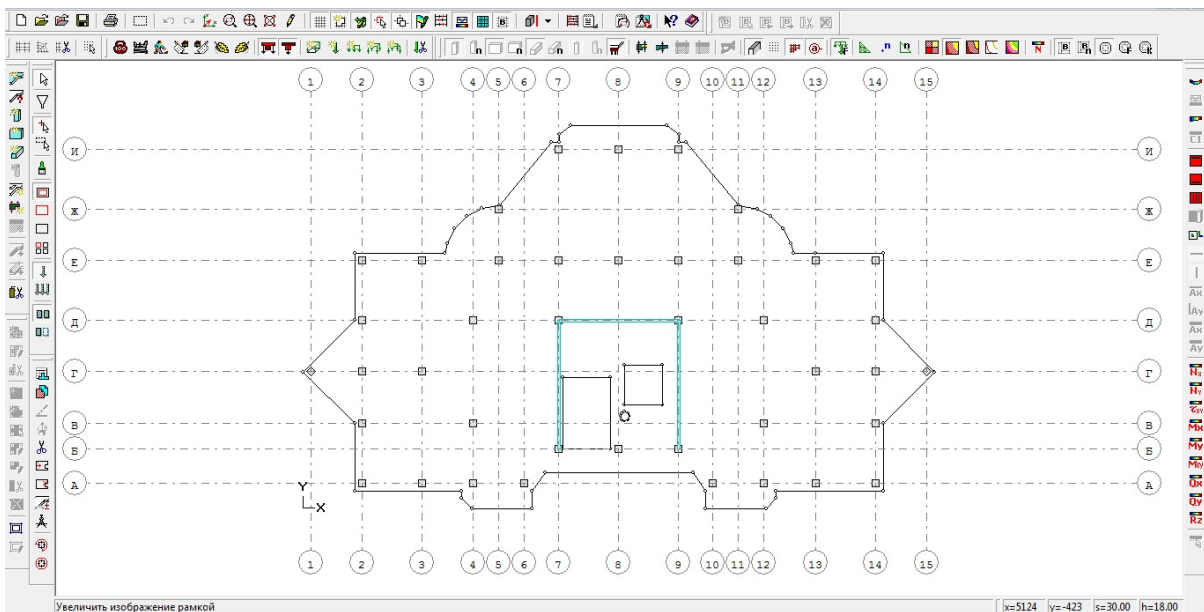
Безбалкове безкапітельне монолітне перекриття
